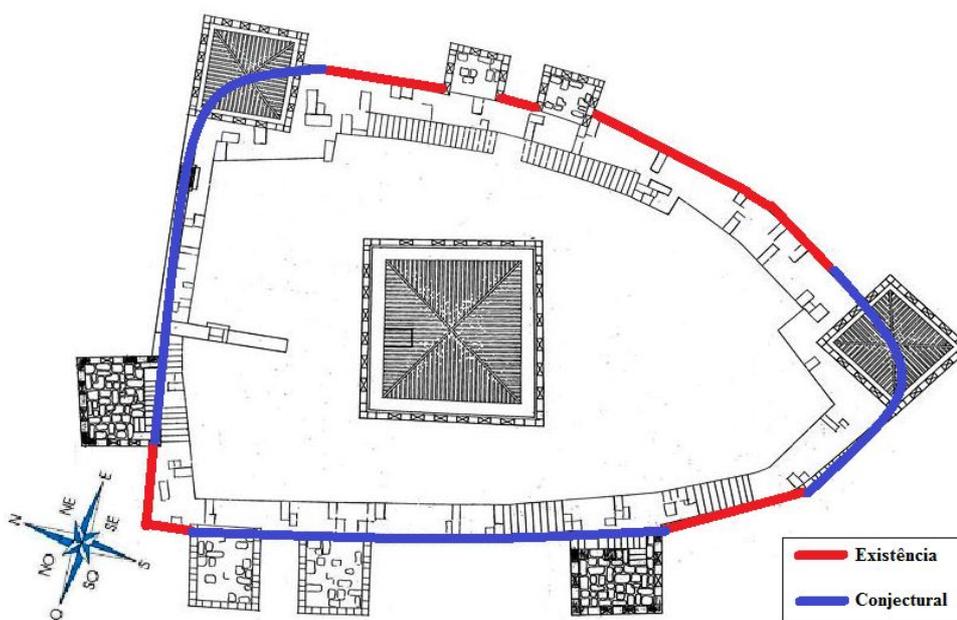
Planta do castelo de Guimarães. Adaptada do site [31]
